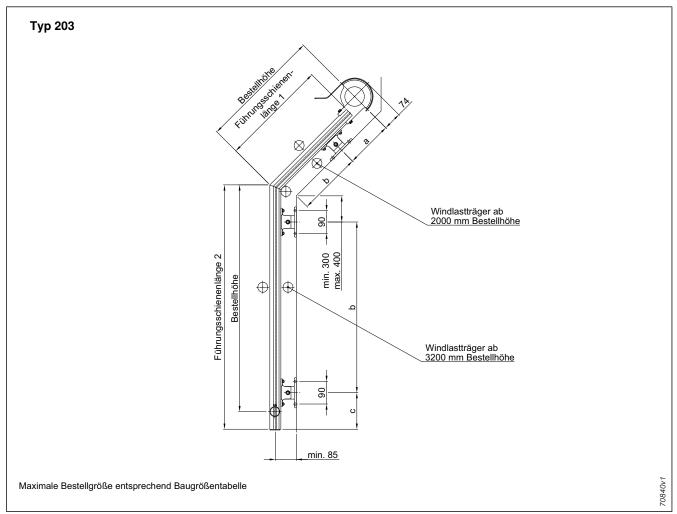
Führungsschienenhalter – Abstände Typ 203
